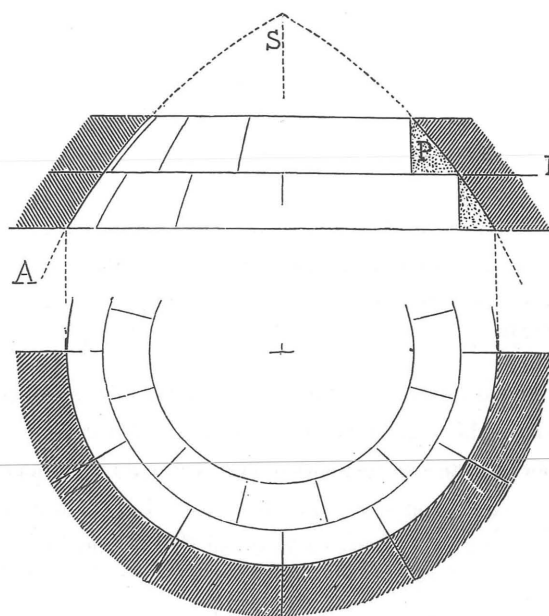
Cúpula arcaica de sillaría, con hiladas horizontales y perfil apuntado
